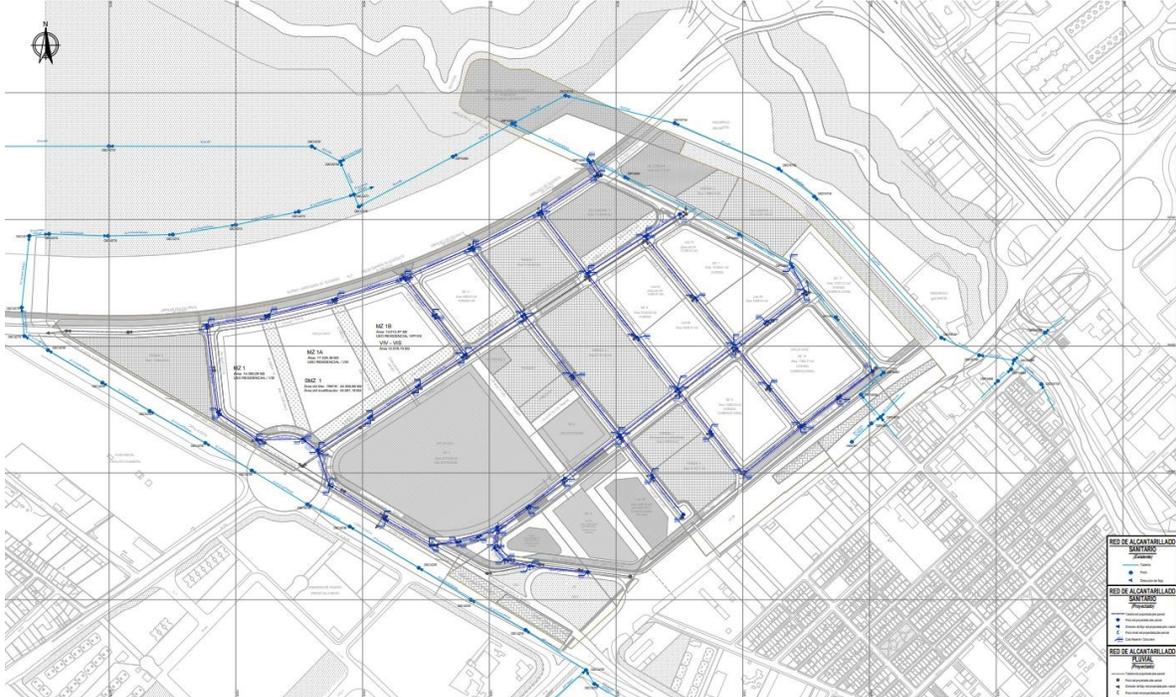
Plano de la red proyectada de alcantarillado pluvial PPD – Áreas de drenaje
